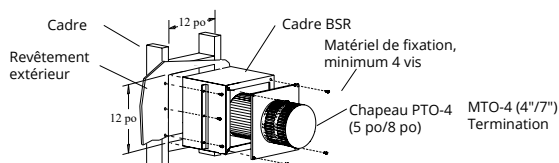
c Installation d'un chapeau PTO avec le cadre BSR.
